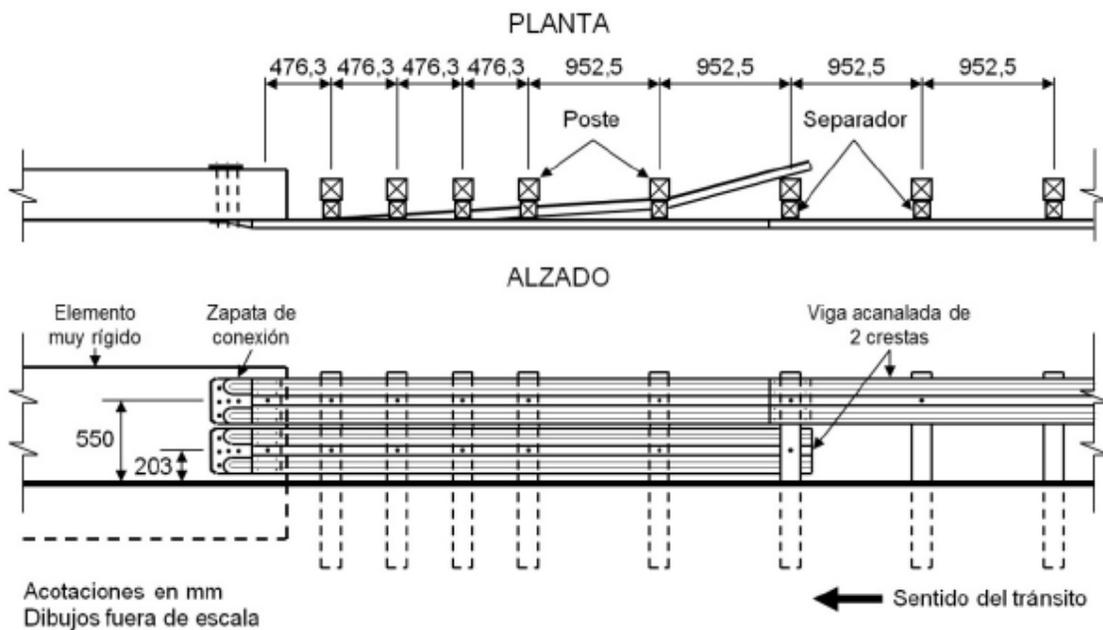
Transición de barrera metálica de doble banda a muro vertical recto
